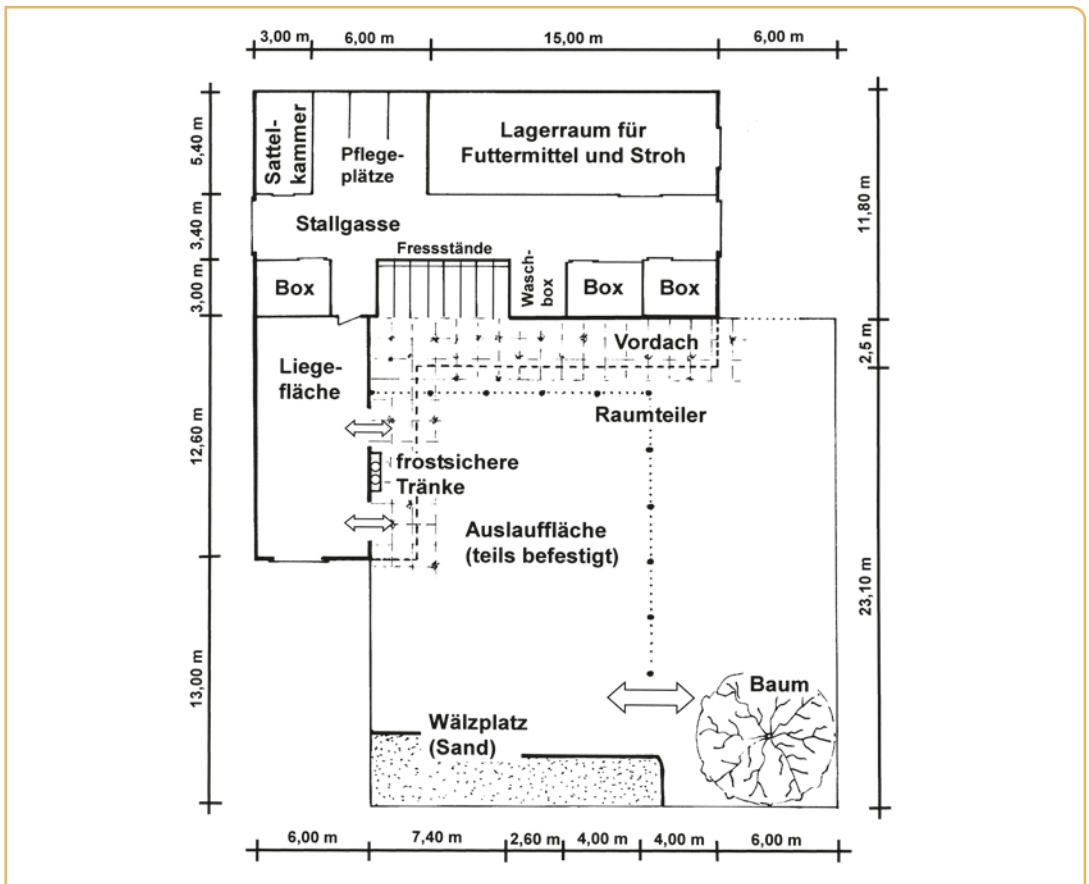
Mehrraumlaufstall mit Fressständen für 8 Pferde (Warmblut) und 3 Einzelboxen.
